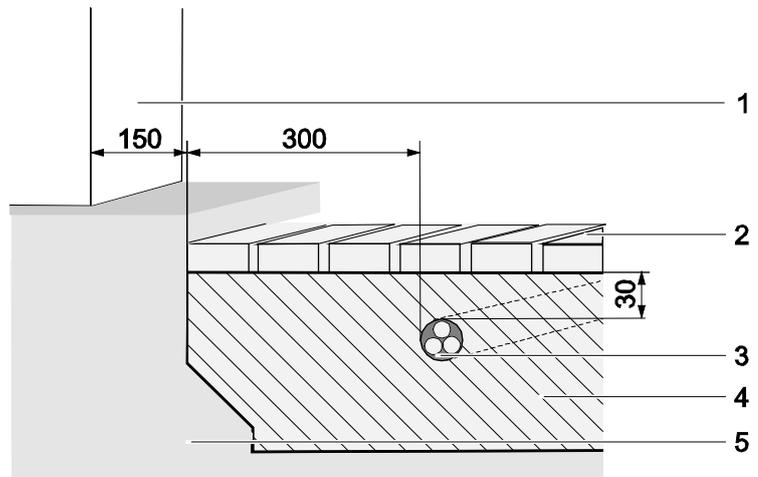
Induktionsschleife in Bitumen, Asphalt oder Beton verlegen (Maße in mm)
